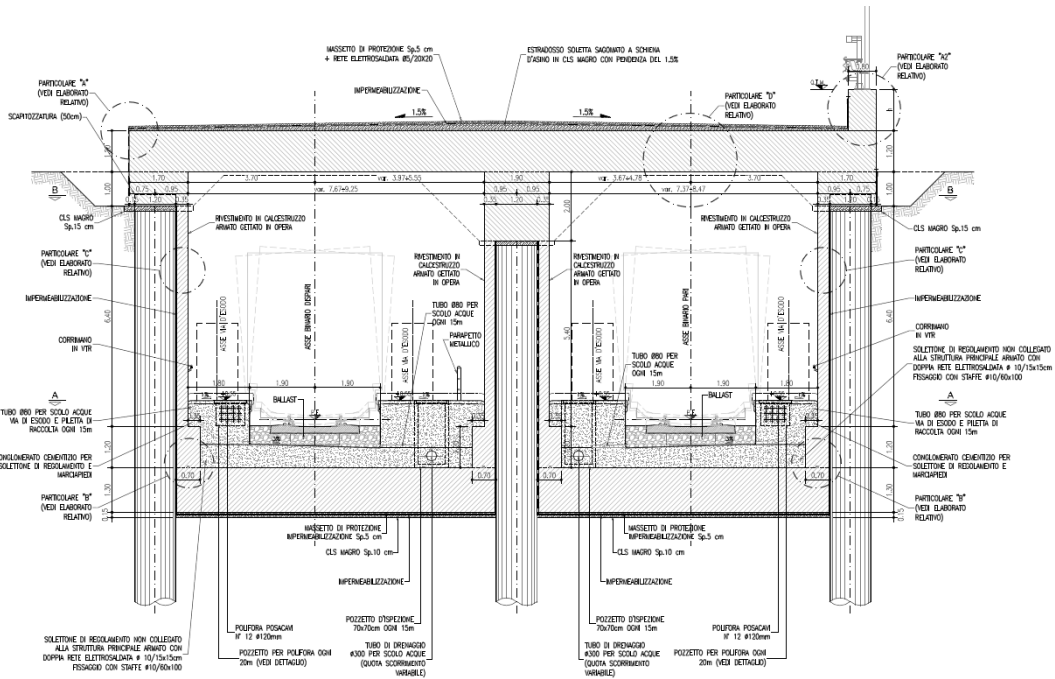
Sezione tipica M2 bis (doppia canna con setto finestrato)
